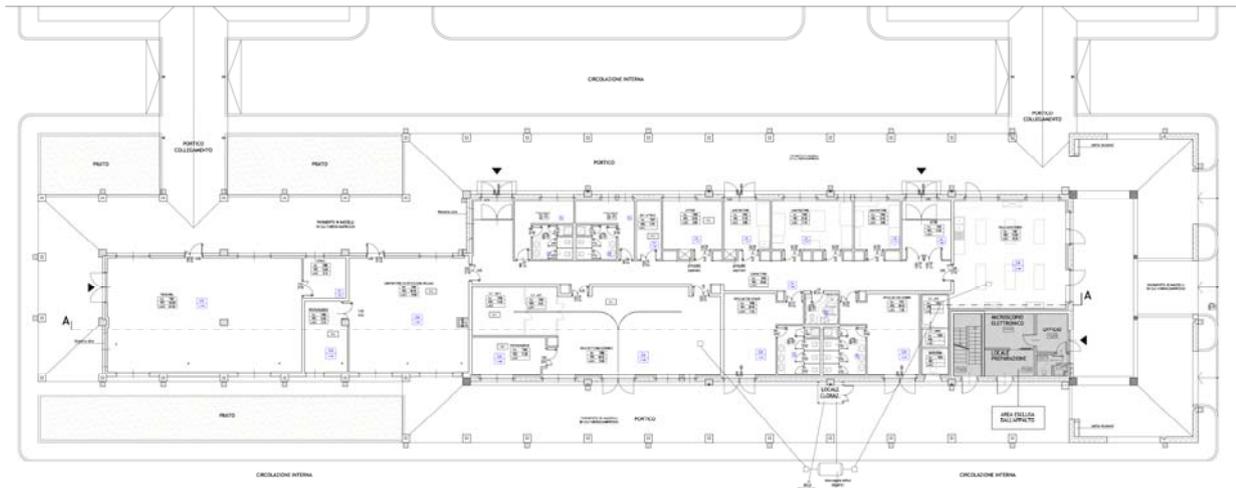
Sale Settorie - Pianta piano terra - Progetto - fuori scala
